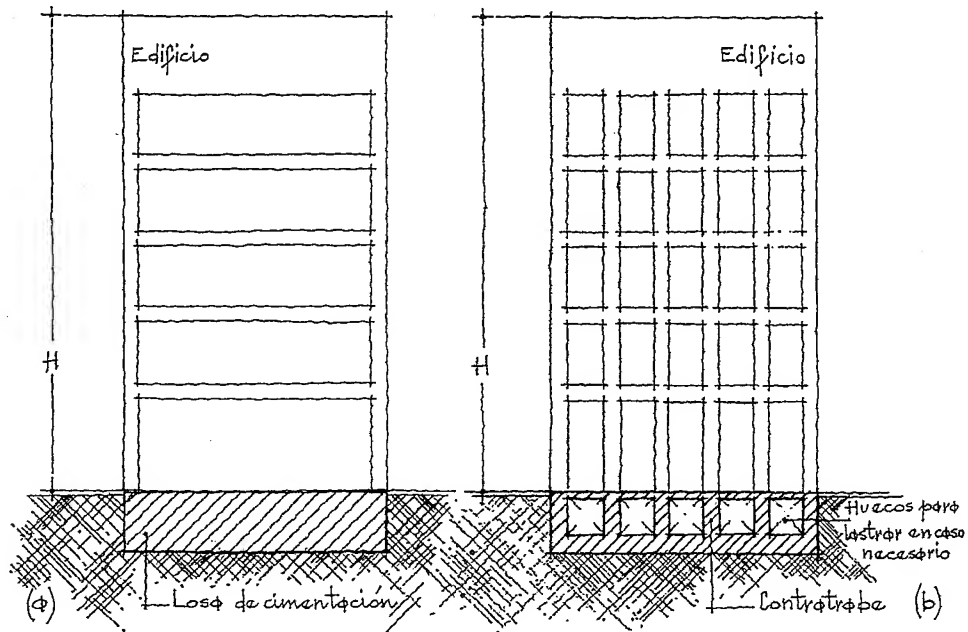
Corte transversal de la losa de cimentación. Detalle, (b)
